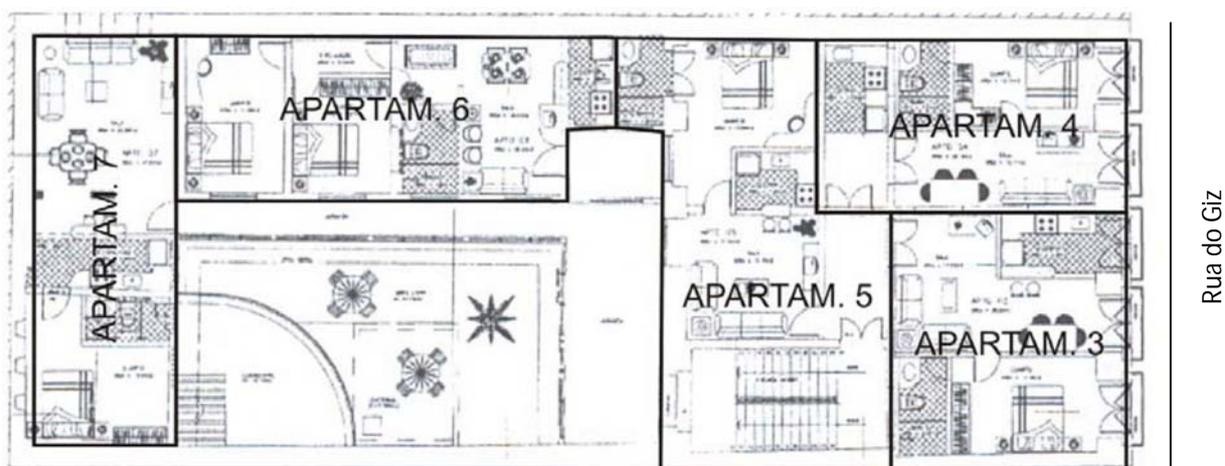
Planta do 1º pavimento na rua do Giz nº 117 – sem escala. LIMA et al, 2004, p.131; AZEREDO, 2006, p.53.
